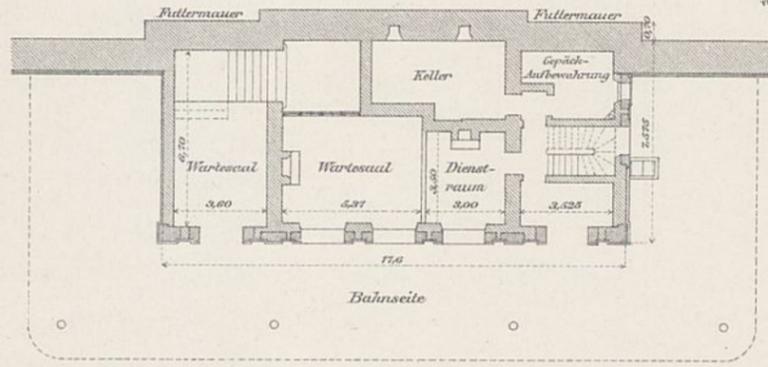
Grundriss in Schienenhöhe. 1:300.
